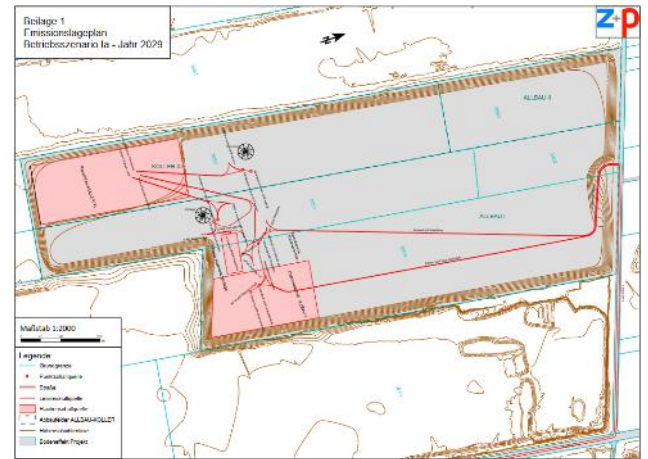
Übersichtsplan (Quelle: Fachbeitrag Schalltechnik, Einlage B.3.16.0.0)
